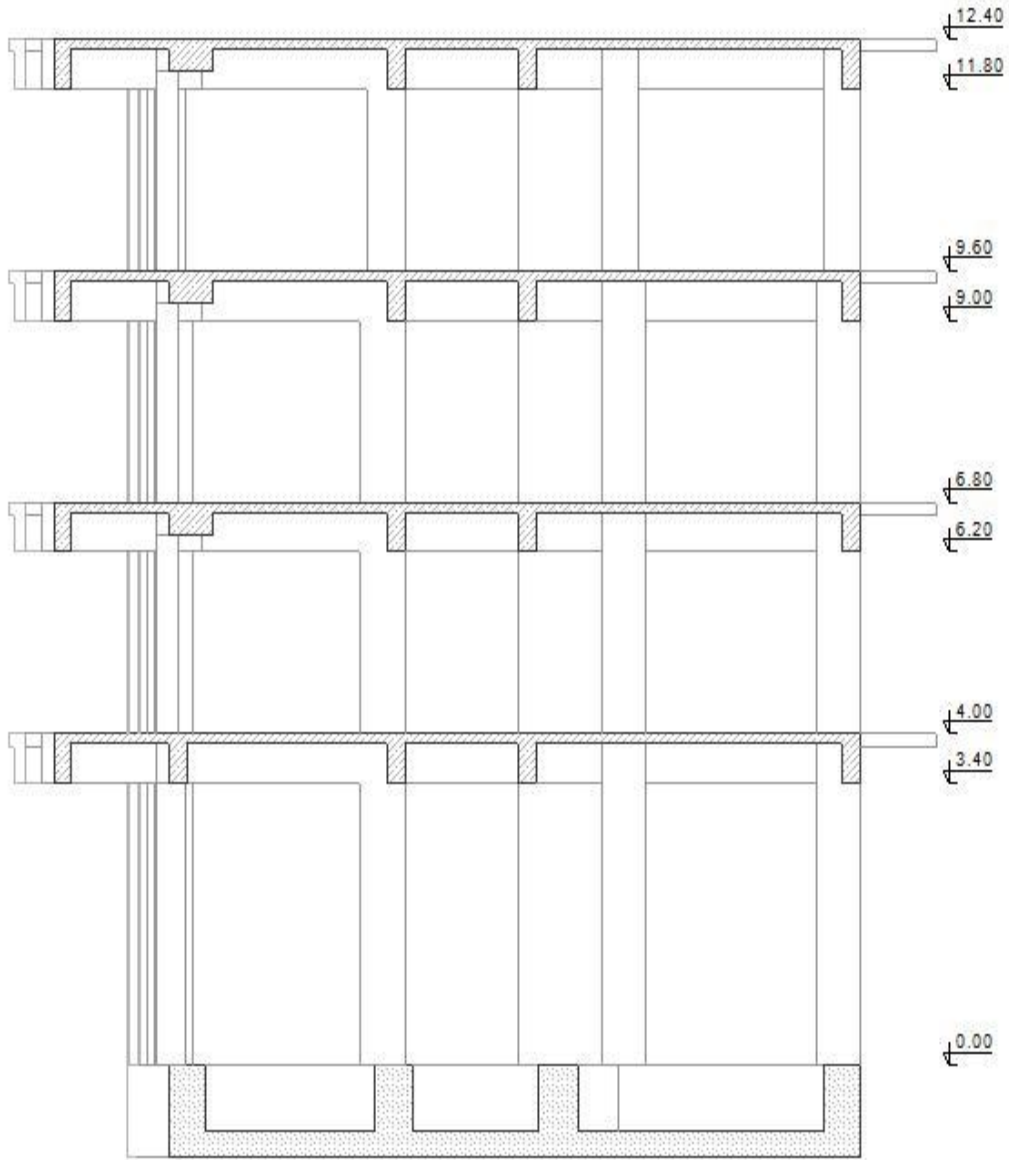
Tip 7 Uygulamasında Bina Planı
